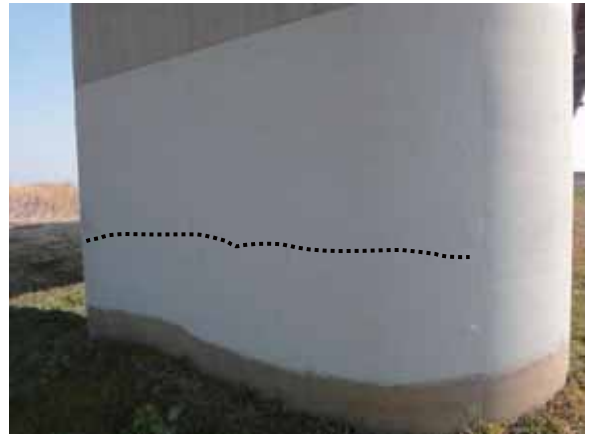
P4 橋脚のひび割れの状況
